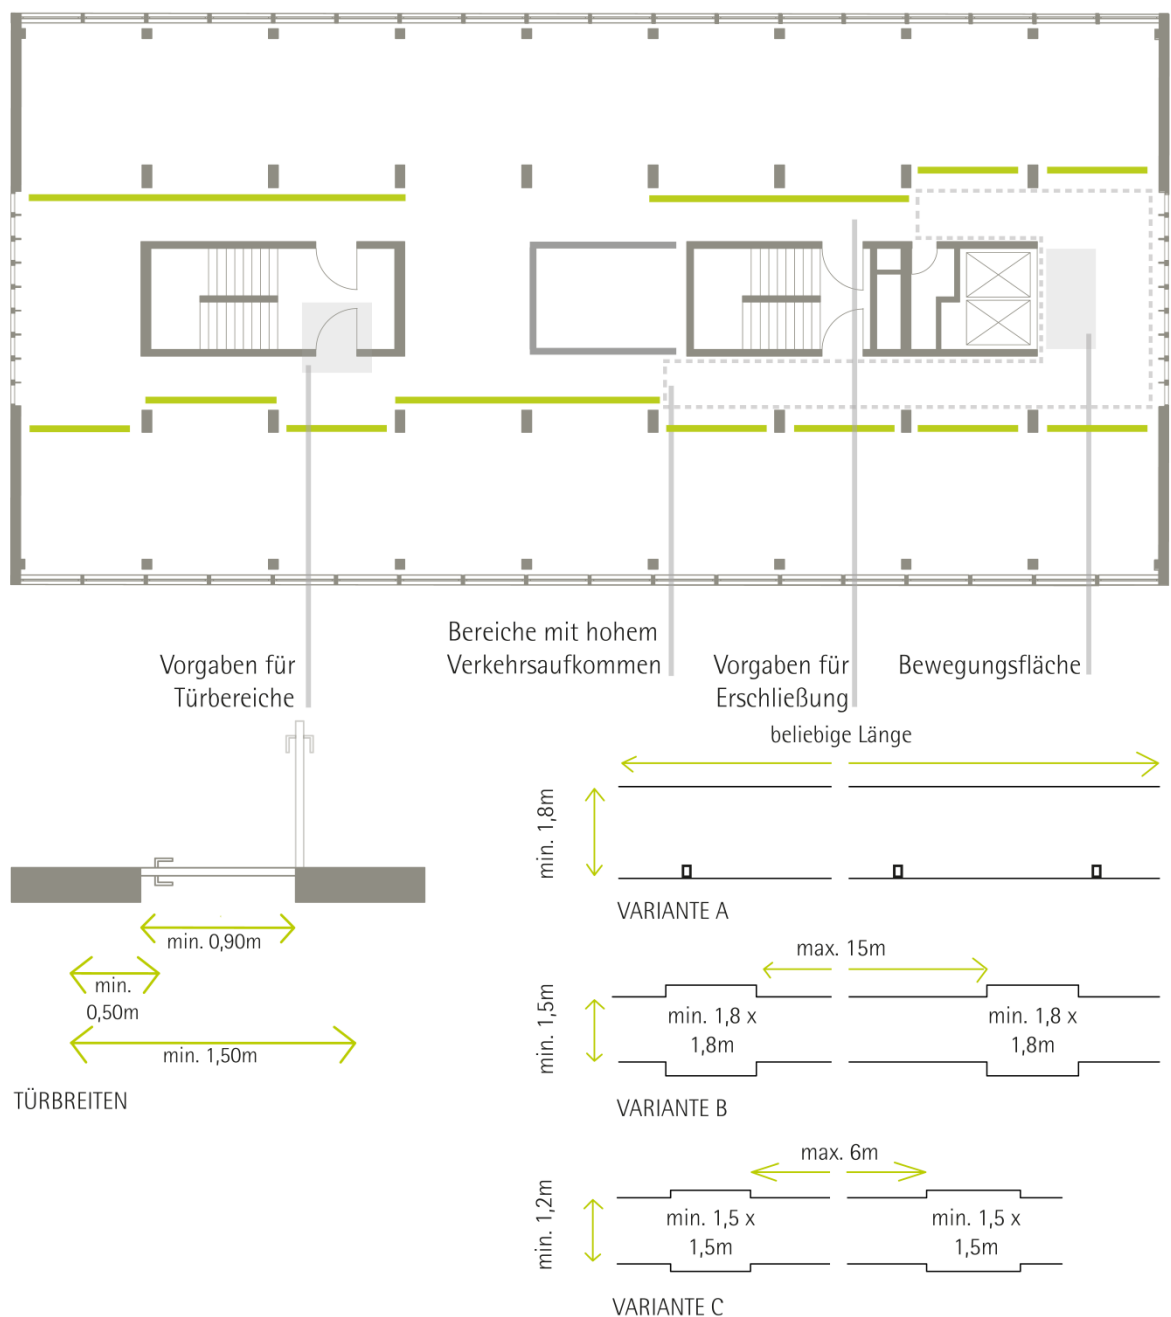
Schematische Darstellung horizontale Erschließung mit Vorgaben für Türbereiche und Erschließung
